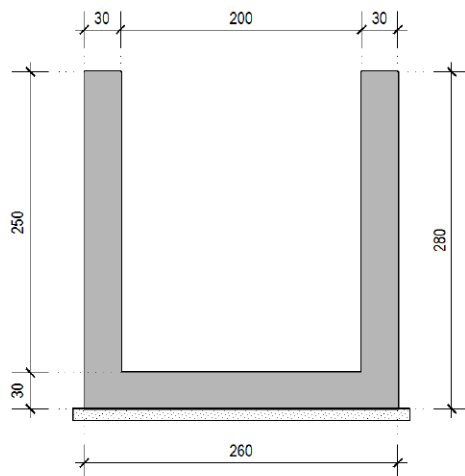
Rio Mortu sezione trasversale 200 x 250
